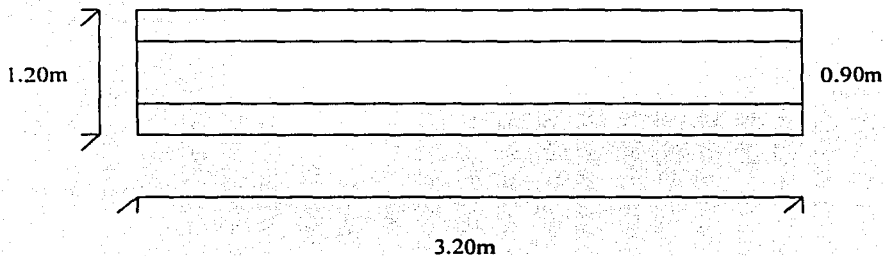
y Fig. 3.4, Sección normal, muros de mampostería de tercera. (corte y planta).
